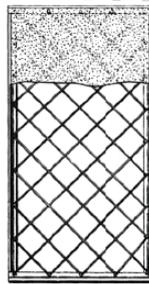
Betonbautafel mit Stahlrahmen, aus KAUFMANN [1]
